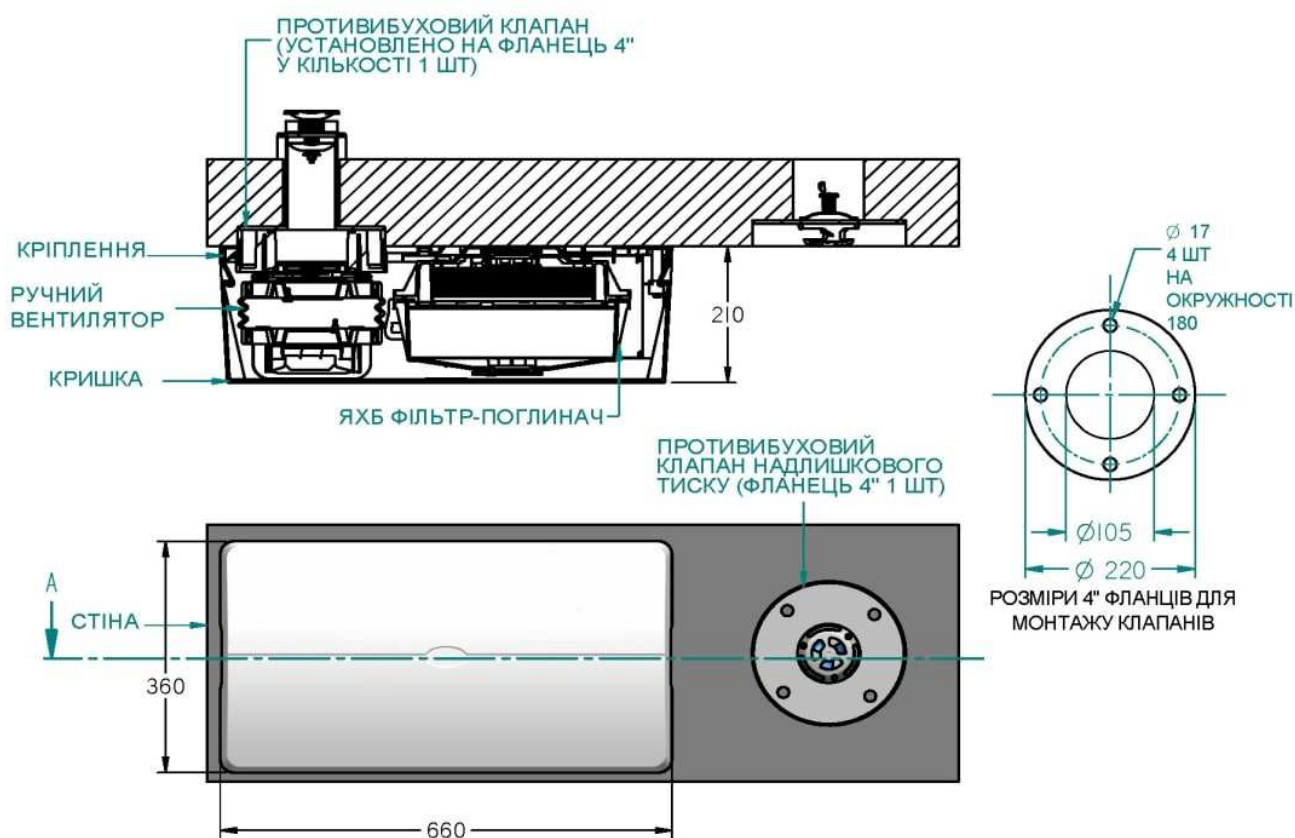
Фільтровентиляційна установка (ФВУ)
